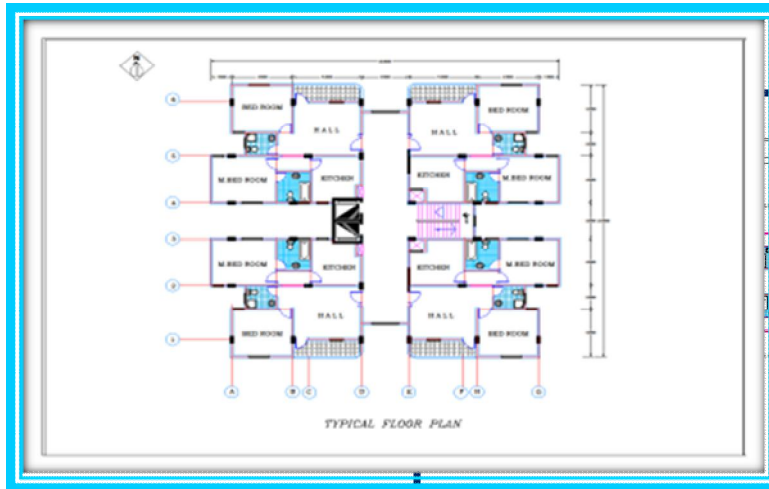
نموذج تصميم الطابق الارضي للمساحات الصغيرة للشقق 120
